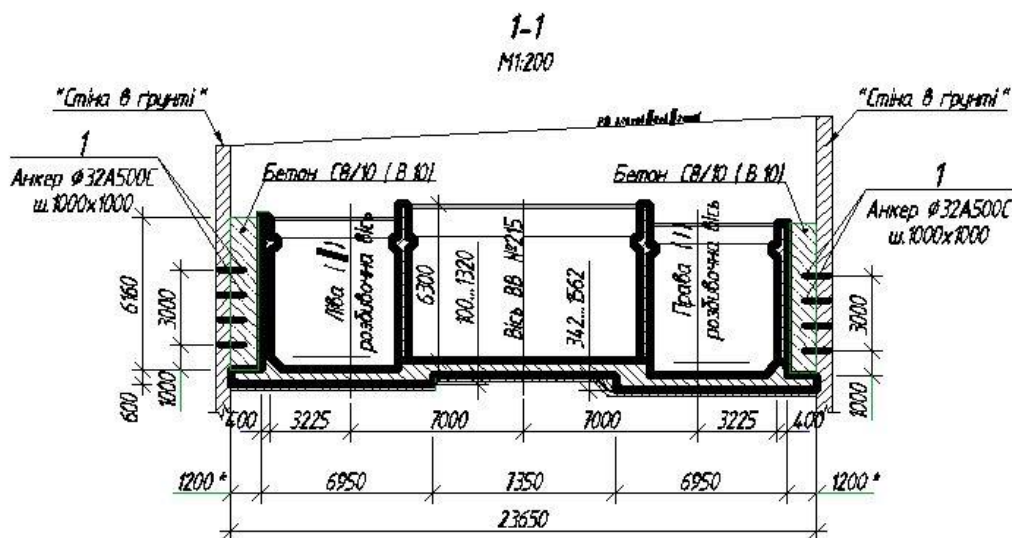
Вентиляційний вузол із вказаним розміщенням пазух, що заповнені бетоном В15, та заанкерованими зі «стіною в ґрунті»
